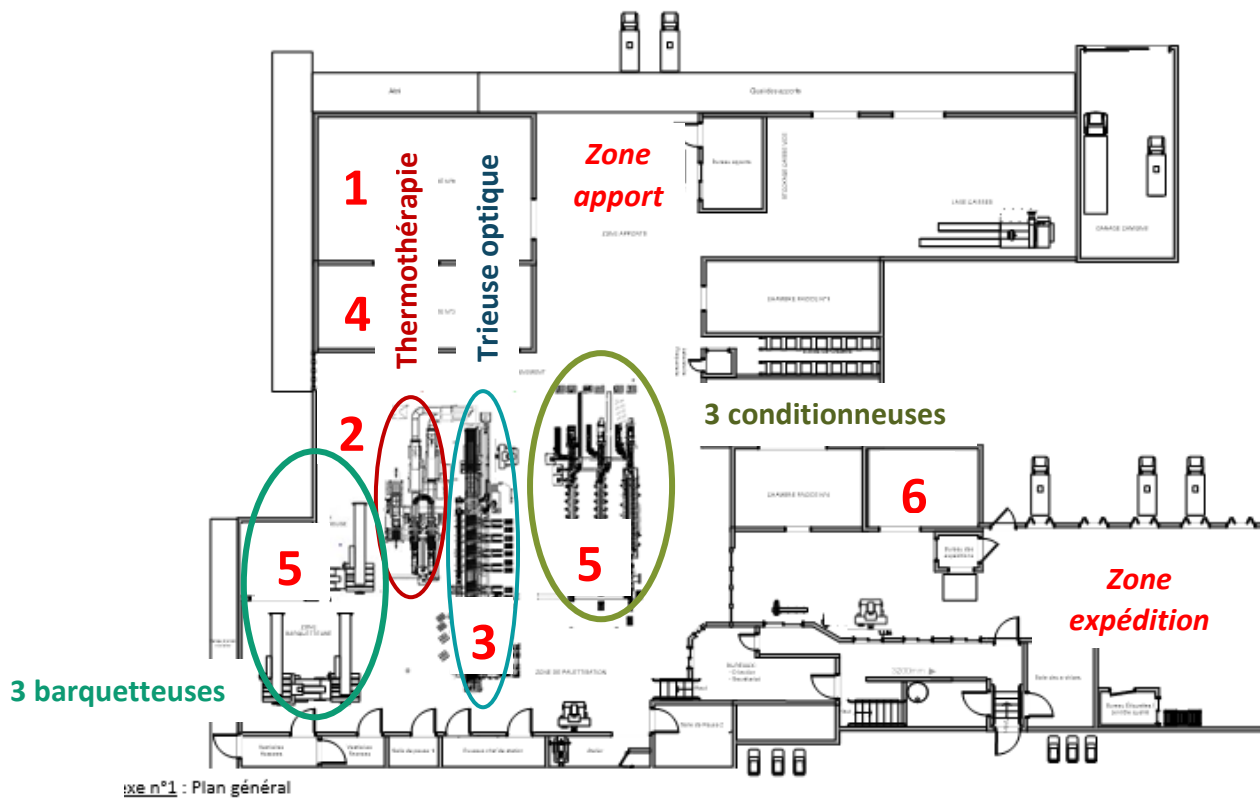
Plan de la station campagne 2017 (Source : interne)
